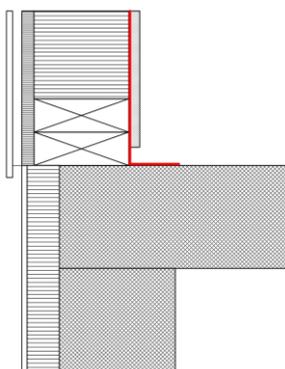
Esempio di un raccordo tra pavimento e parete esterna
